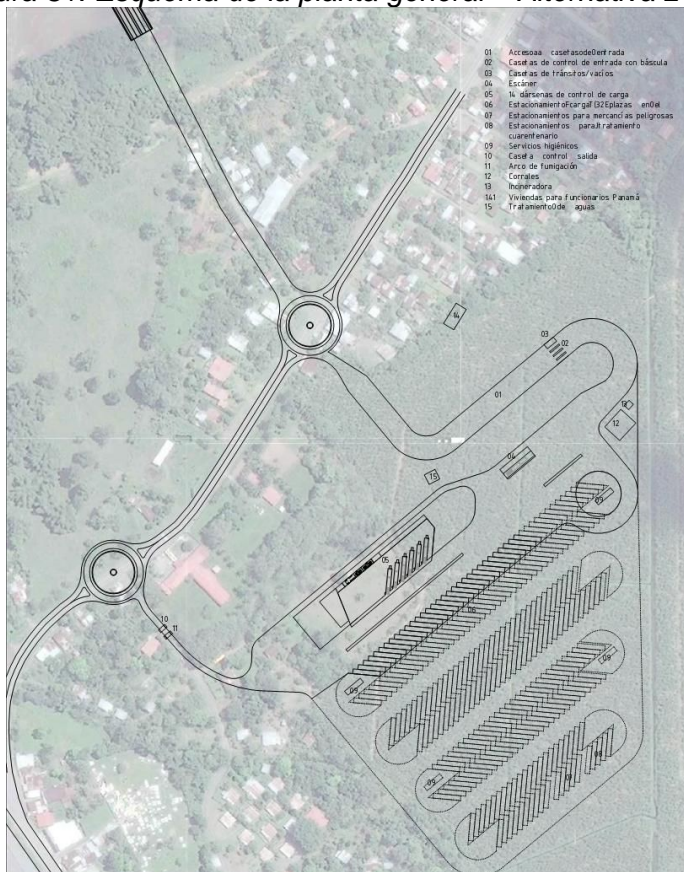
Esquema de la planta general – Alternativa 2 (CR)
